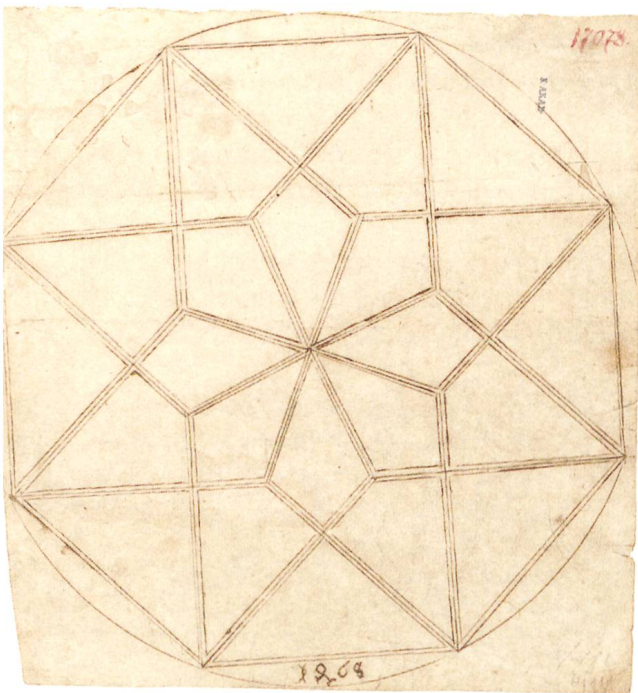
Spezielle Variante eines Haspelsterngewölbes auf rundem Grundriss. Die unten gut leserliche Jahreszahl datiert den Planriss (Inv. Nr. 17078) in das Jahr 1468.
